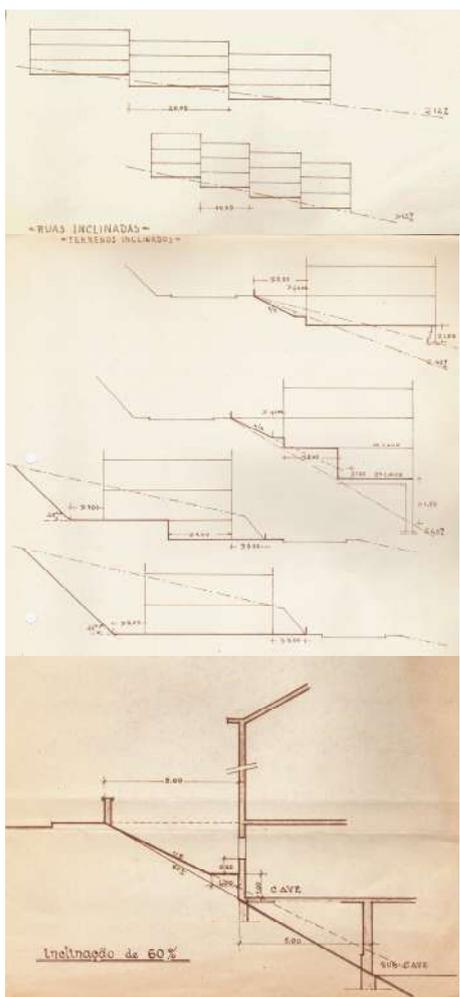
Urbanização, Alargamento e Embelezamento de Coimbra. Detalhe de implantação do edificado (De Gröer, 1940).
